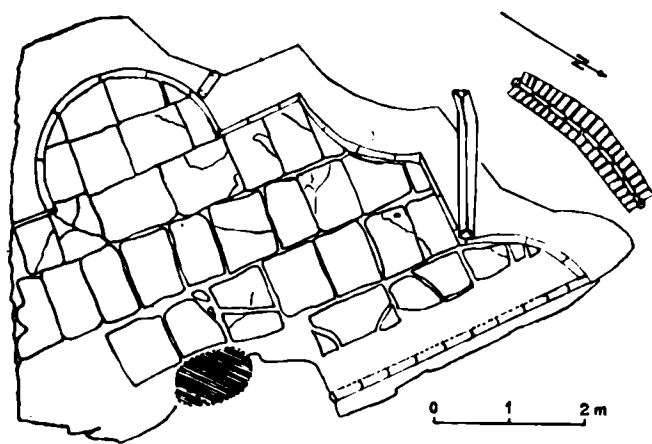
Planul construcției din sec. XVIII, descoperită în Piața Splaiului.
